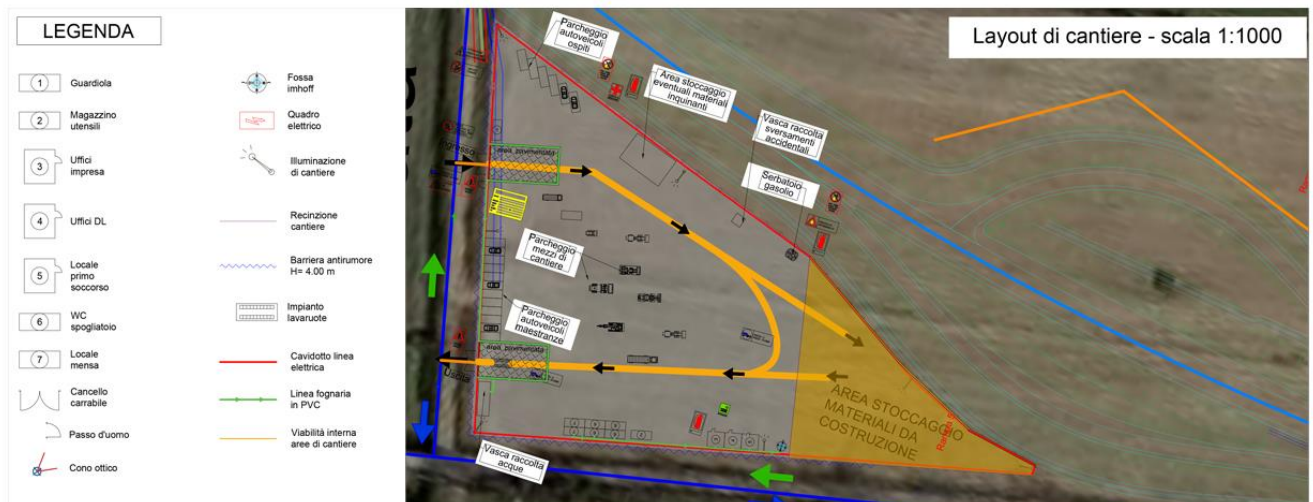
Stralcio planimetrico CO1 cantiere Operativo 1- AS2 Area di stoccaggio 2
